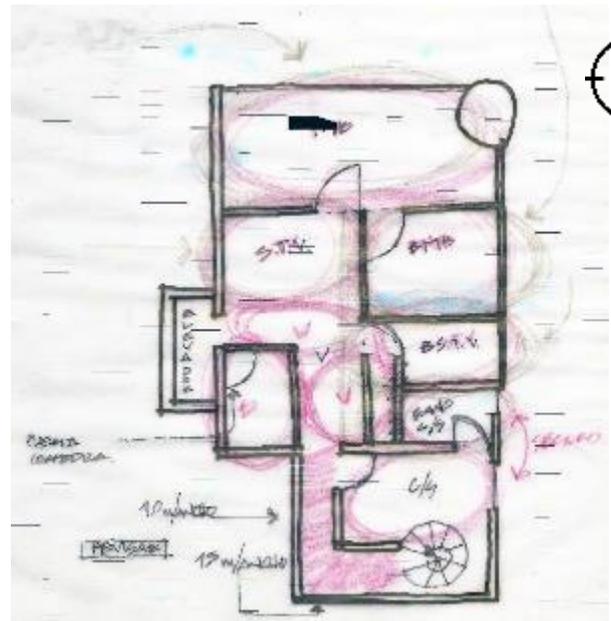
Distribución de áreas en Planta Sótano. Opción 3
